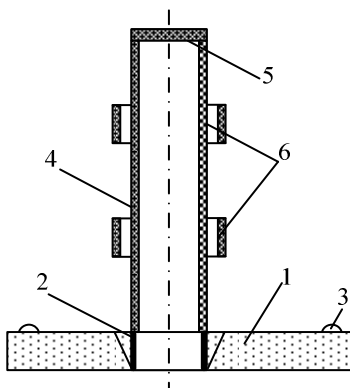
Блок мусоропровода: 1 – фрагмент плиты перекрытия; 2 – узел опоры ствола; 3 – монтажные петли; 4 – фрагмент ствола; 5 – заглушённый торец ствола; 6 – узел сочленения звеньев ствола
